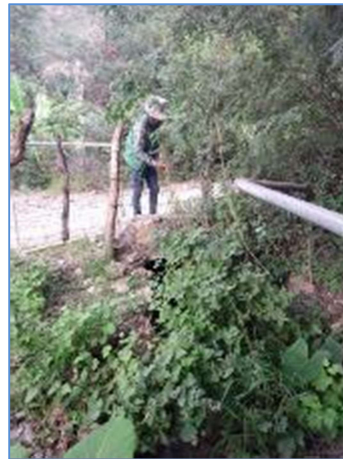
Fotografías del estado actual “Obra de drenaje 4”
